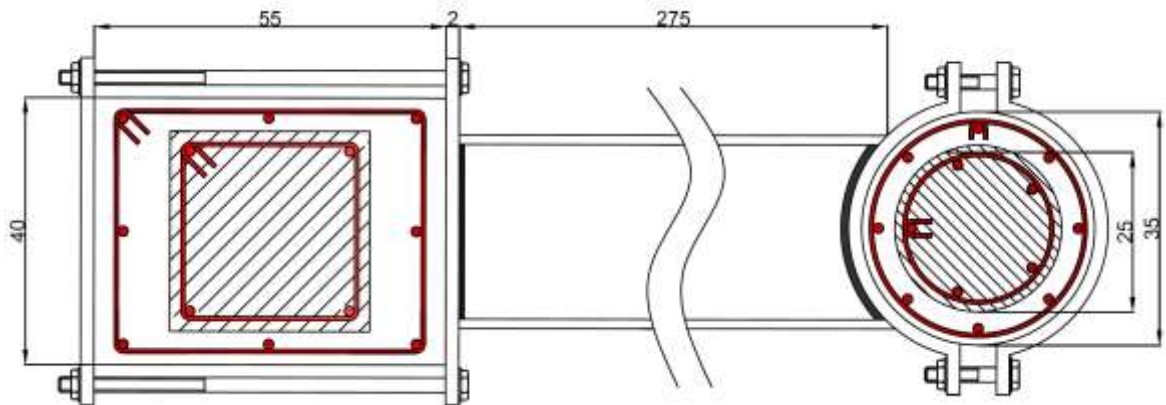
Longrine de profilé HEA300 soudé à l'extrémité par deux platines
